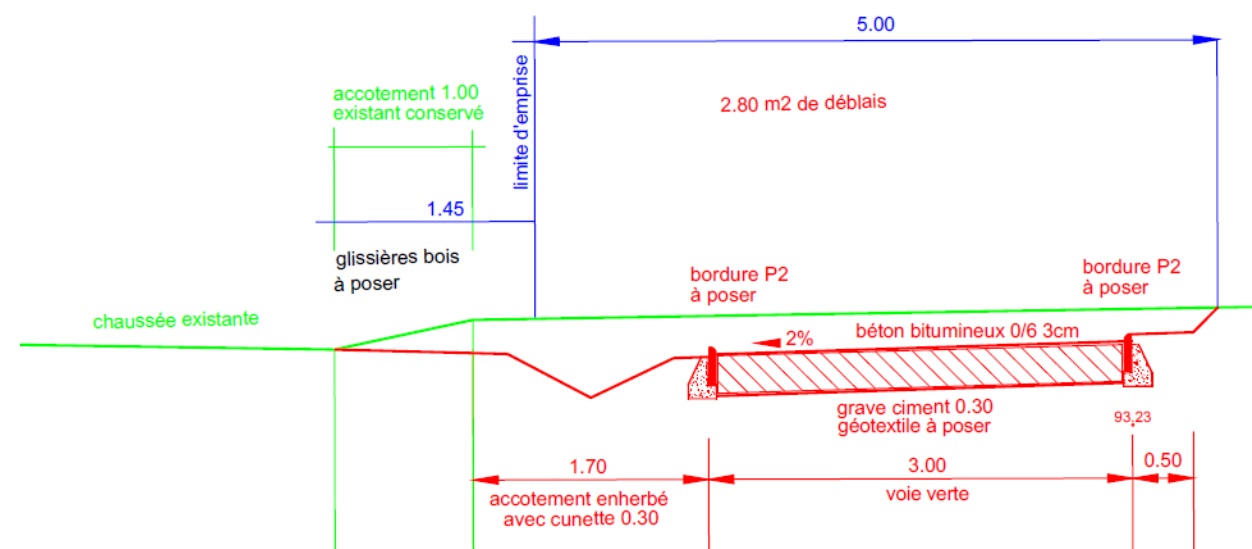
Profil en travers type de l'aménagement de la voie verte
